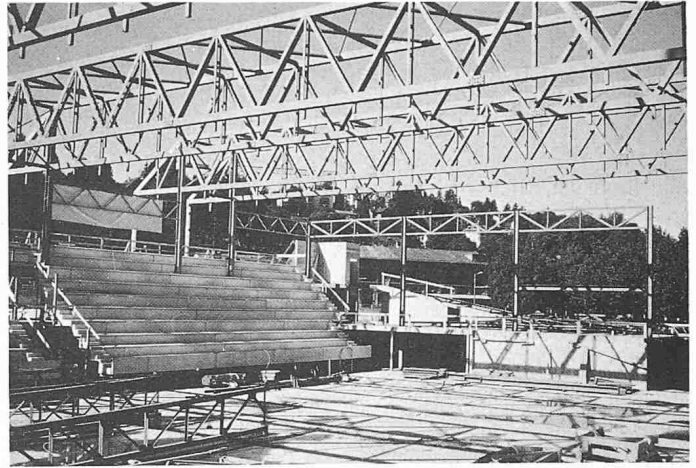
Auf der Baustelle lassen sich keine Fehler vertuschen. Montagevorgänge verlaufen nach genauem Plan
